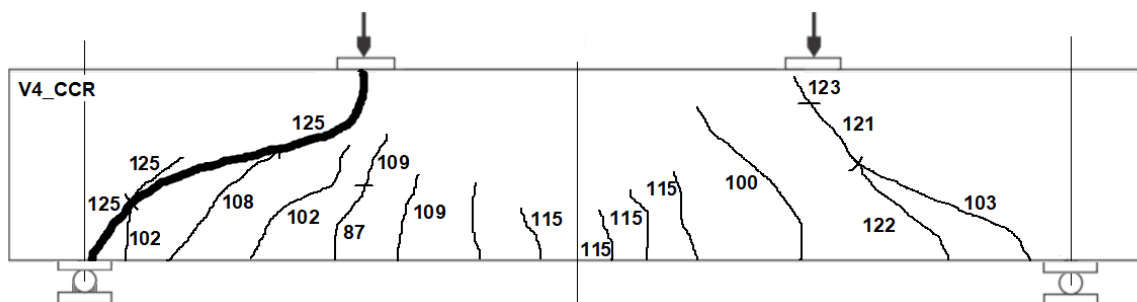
Esquema de fissuração da Viga 4_CCR.
